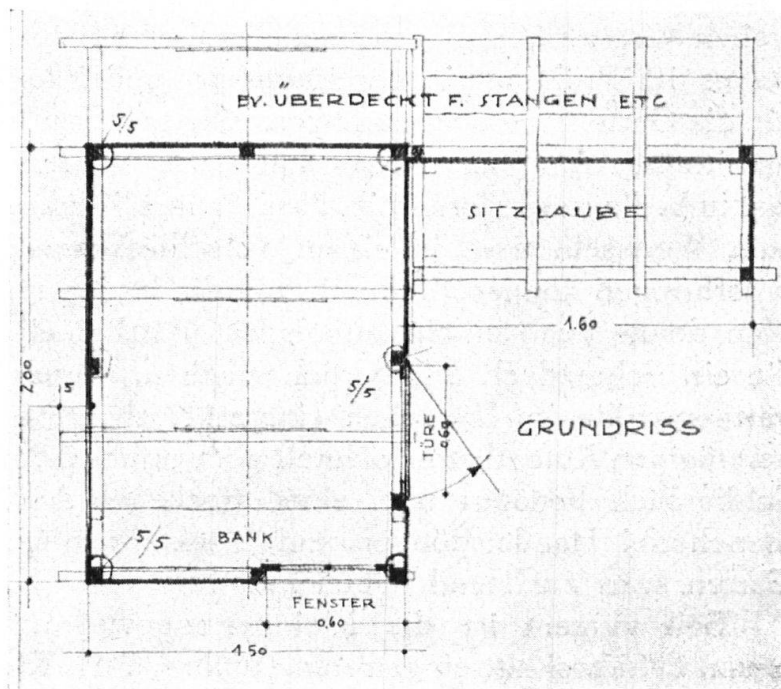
Prämiierter Entwurf „Heimelig“. Grundriss. — Fig. 7. Projet primé „Heimelig“. Plan.
